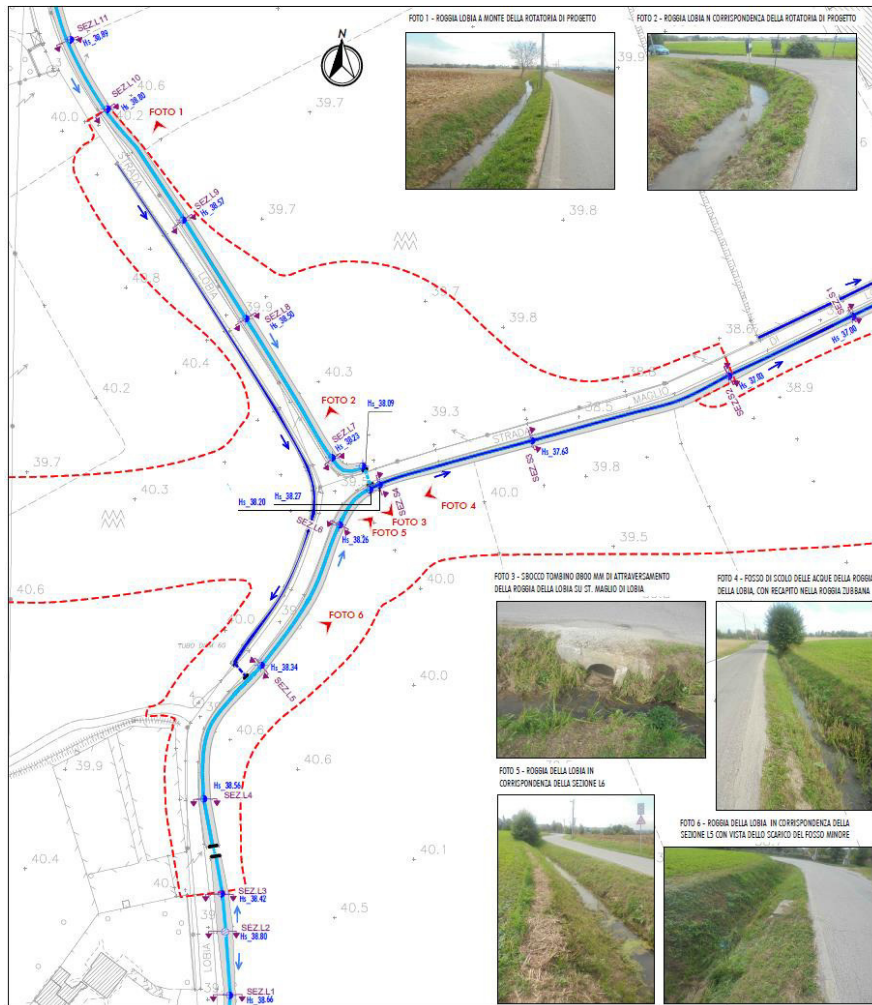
PLANIMETRIA STATO DI FATTO CON RILIEVO FOTOGRAFICO DELLA ROGGIA DELLA LOBIA
